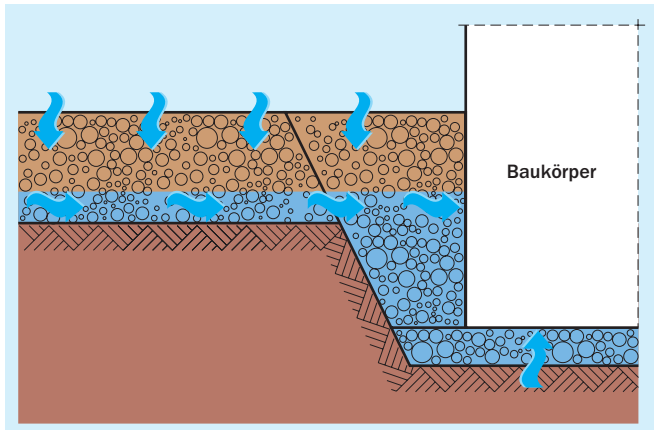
Schichtenwasser (geotechnisch: Stauwasser) mit hochliegendem Strömungshorizont
